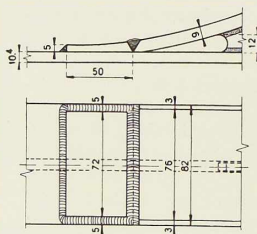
Détails de construction des nœuds types n° 4 et 7 (fig. 311).
